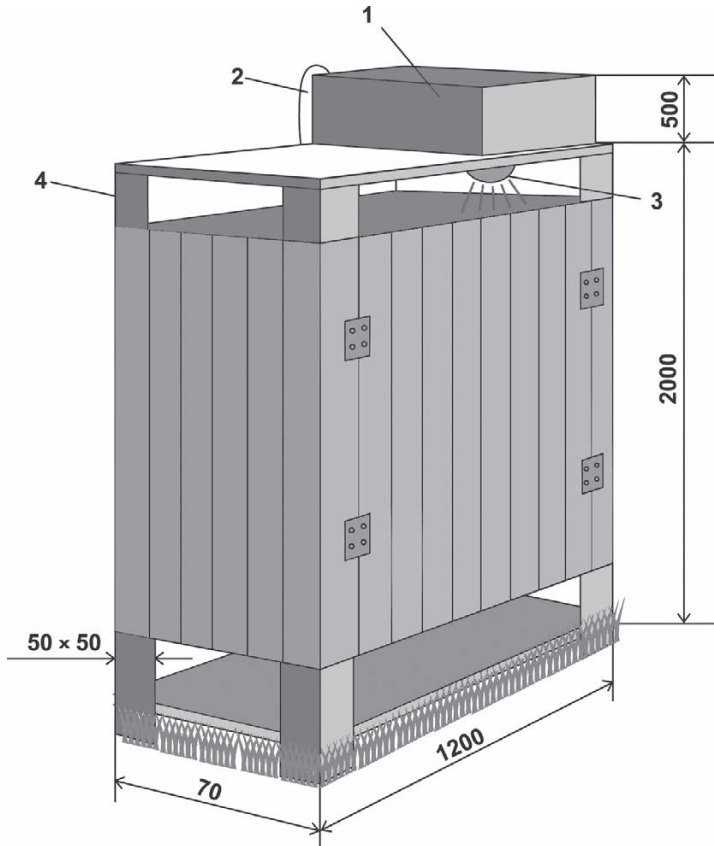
Схема летнего душа (мм): 1 — водонагревательный бак; 2 — впускная труба; 3 — душ; 4 — металлический уголок
